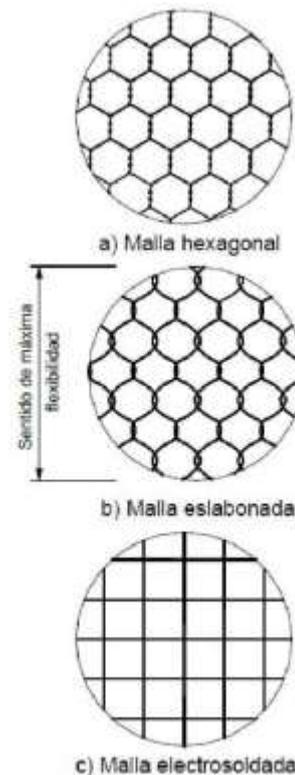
Tipos de mallas utilizadas en la construcción de gaviones. Fuente: (Suárez Díaz, 2001).
